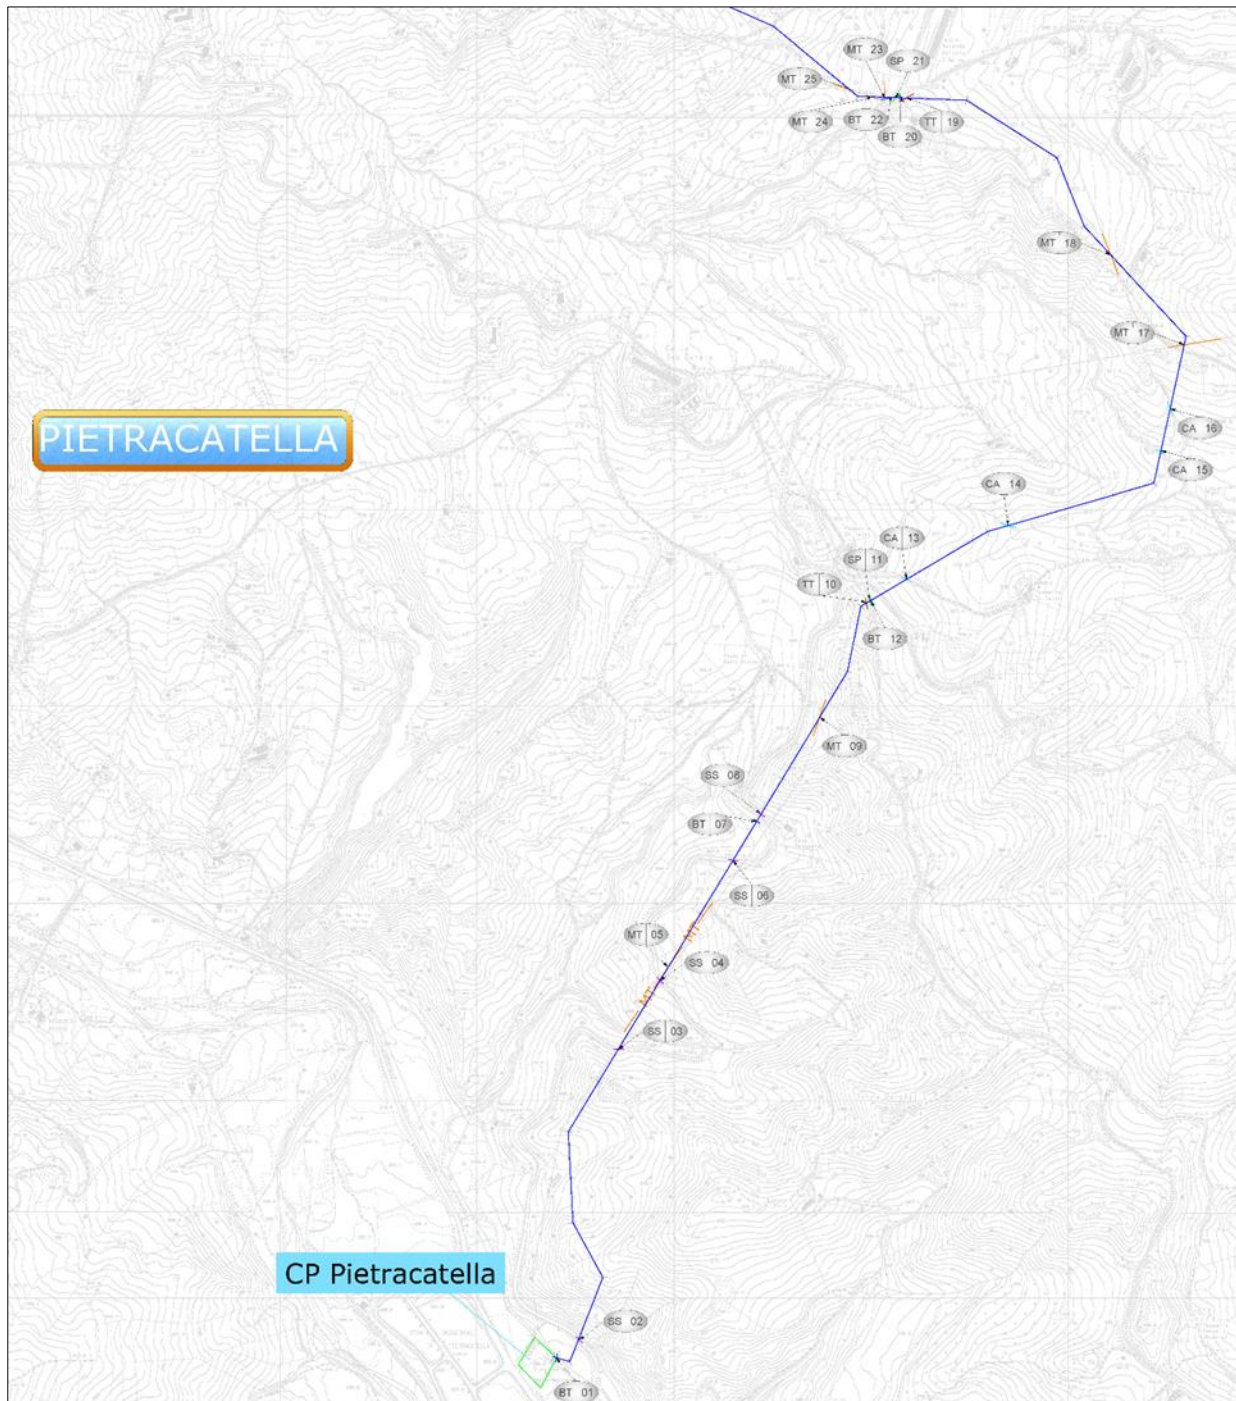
Stralcio planimetria tracciato elettrodoto su CTR (1/5)
